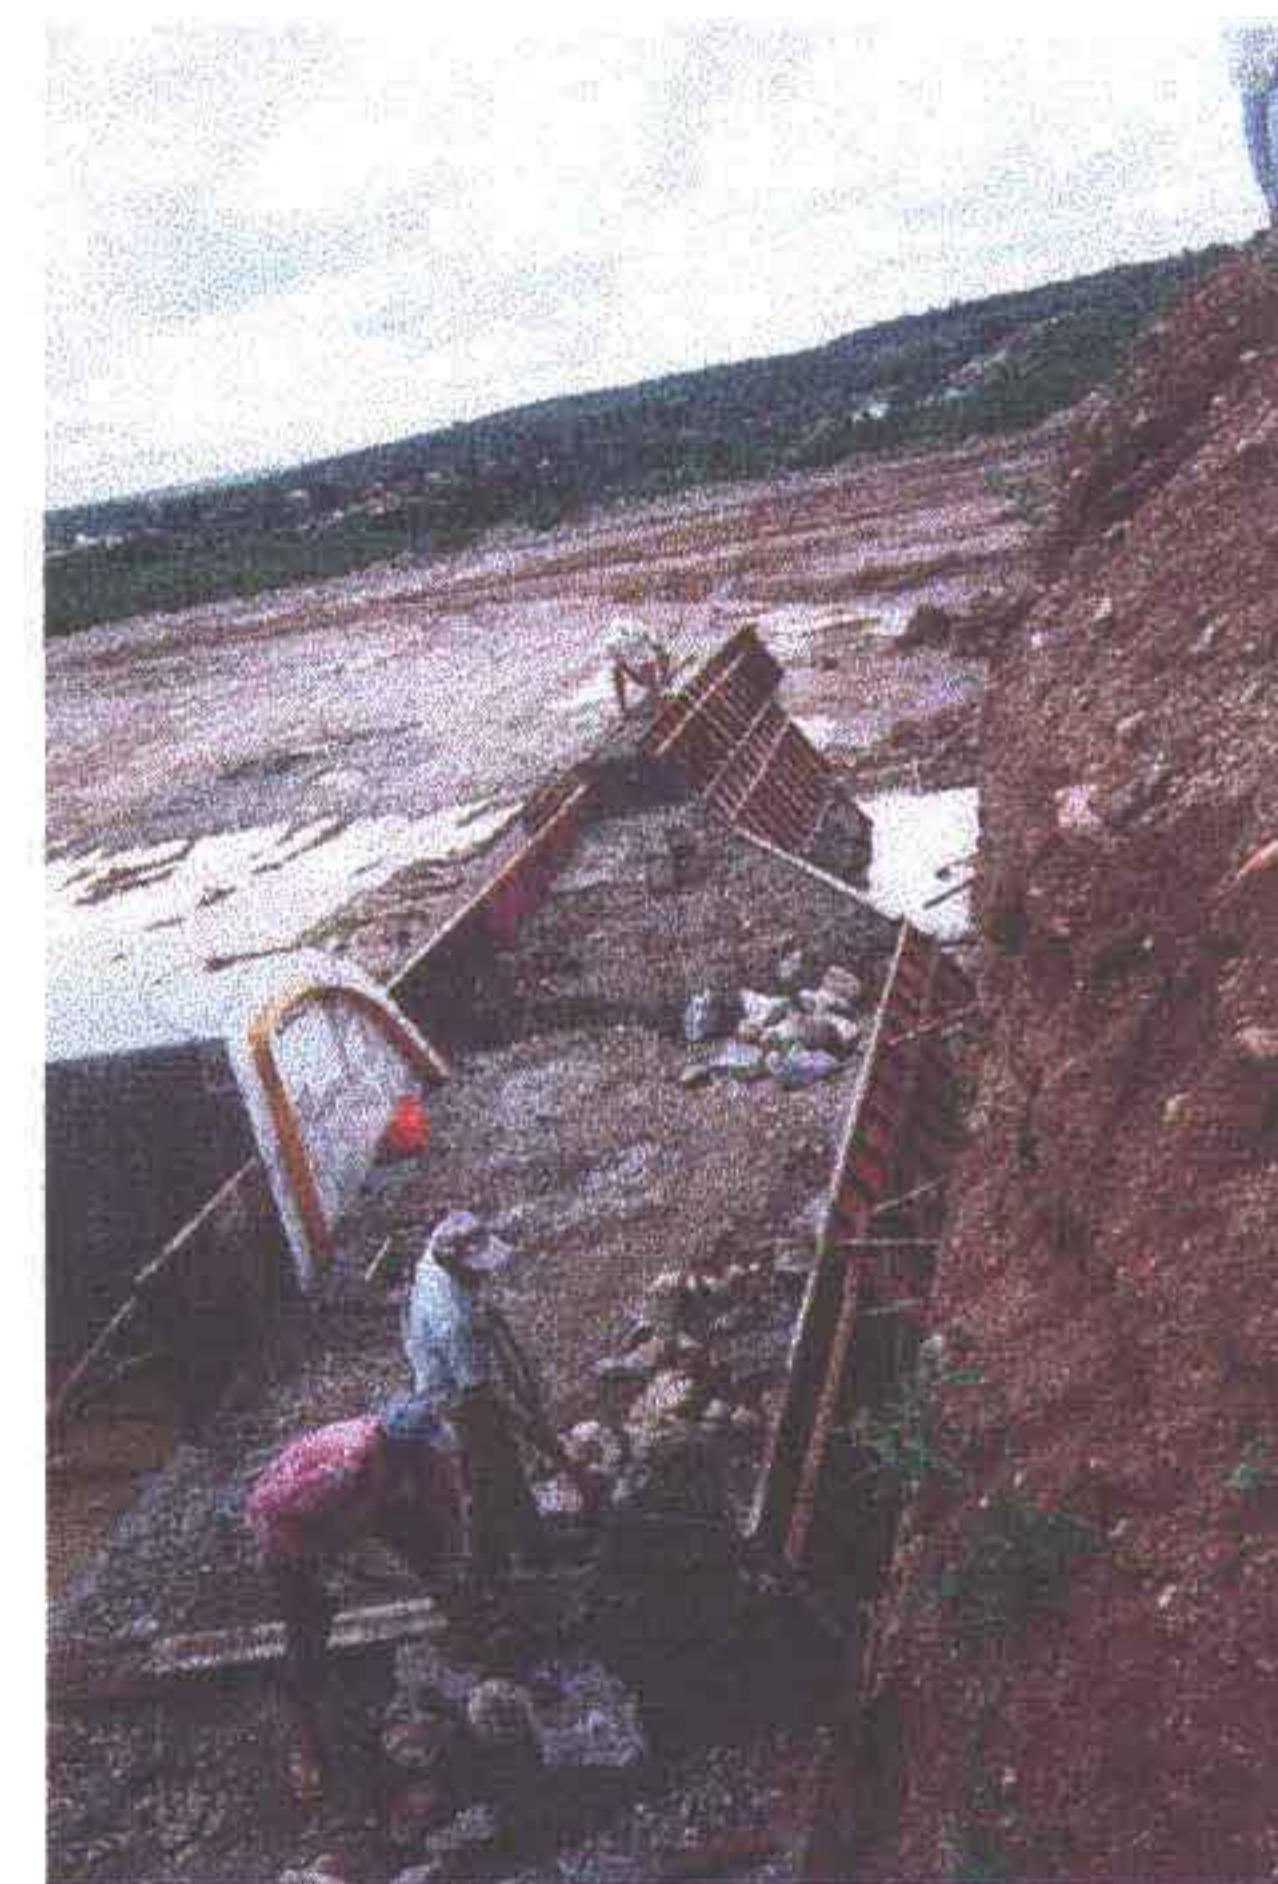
Concretagem do muro, ver a junta fungeband no Creager.
